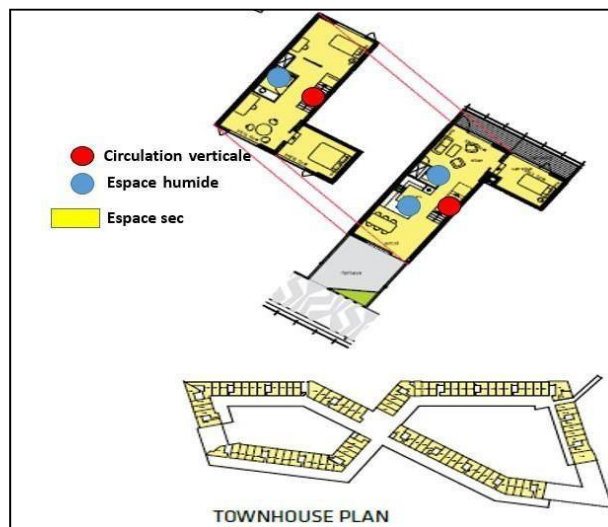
plan du town house, source : <https://www.archdaily.com/>
